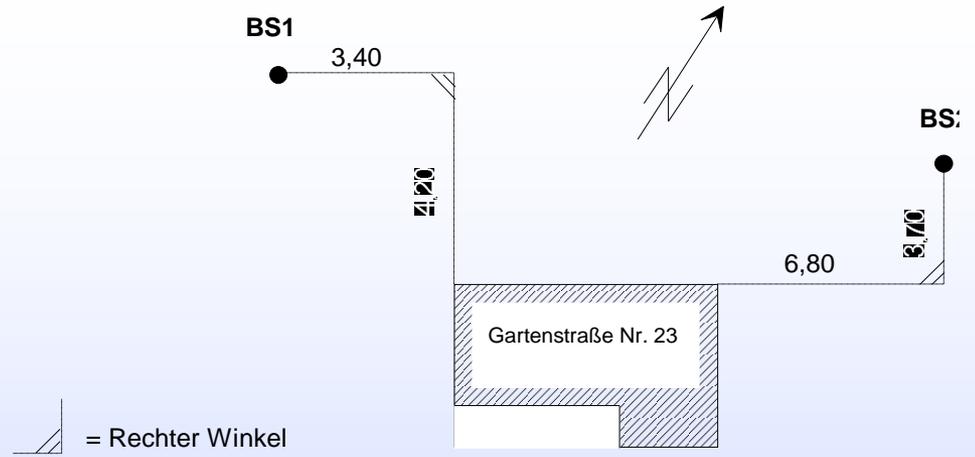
Einmessen von zwei Sondierbohrungen auf ein Gebäude nach dem "Rechtwinkelverfahren" über zwei Gebäudefluchten.
